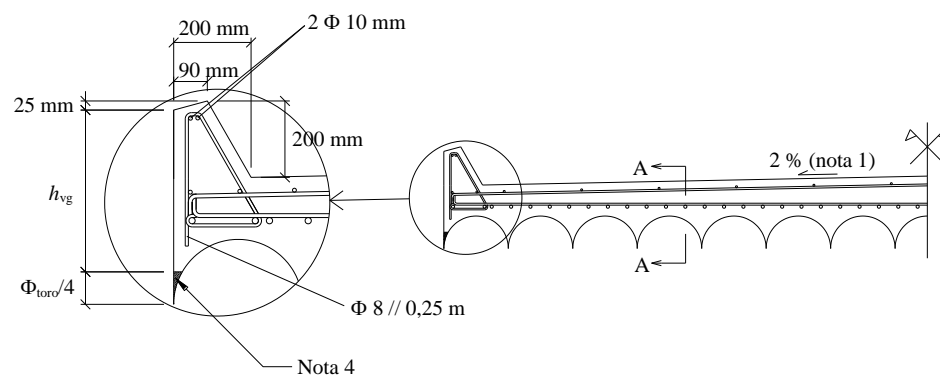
Secção transversal da laje de betão armado e das vigas de bordadura.
